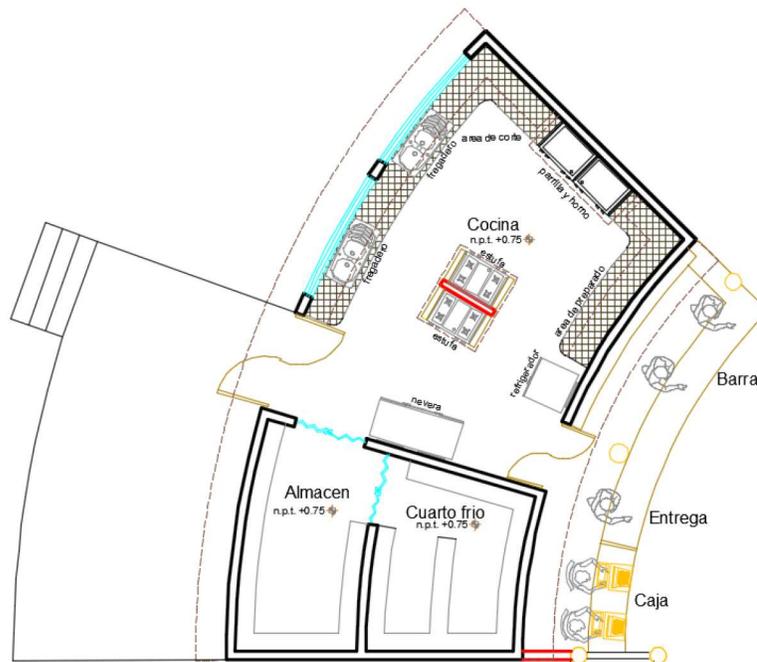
Vista de planta de conjunto del área de cocina del restaurant-palapa principal del proyecto.
